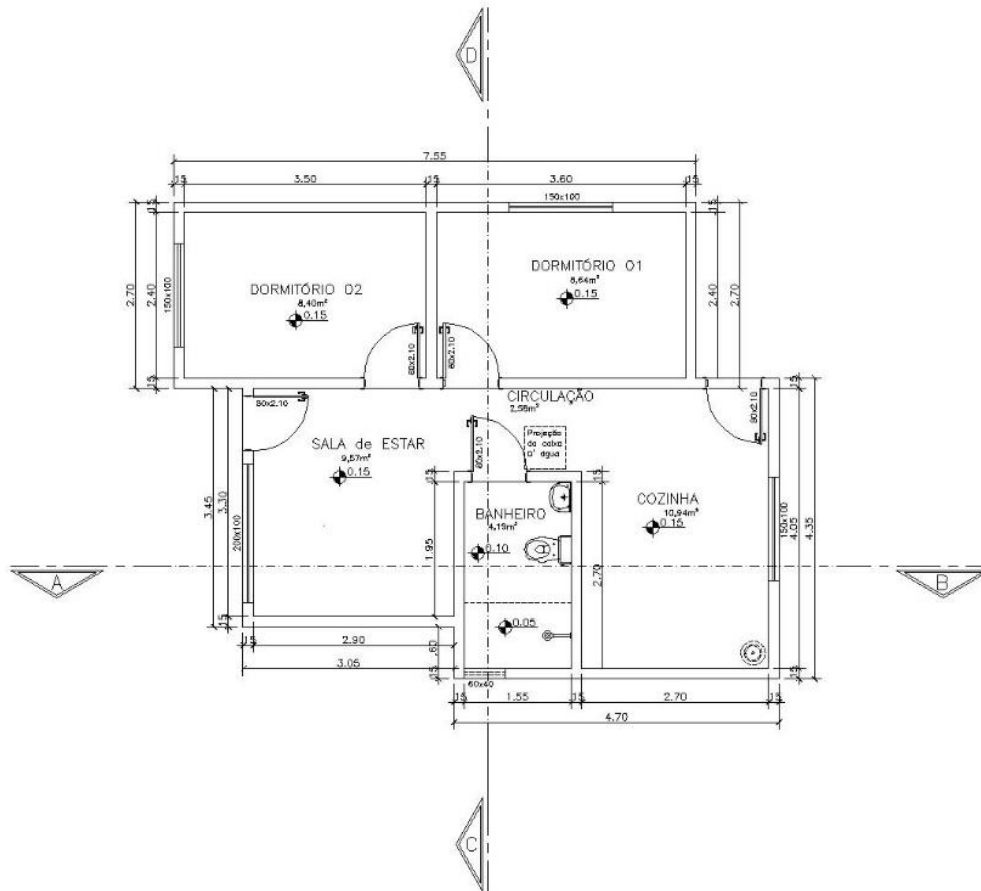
Planta baixa – Fonte: Autor, (2018).
